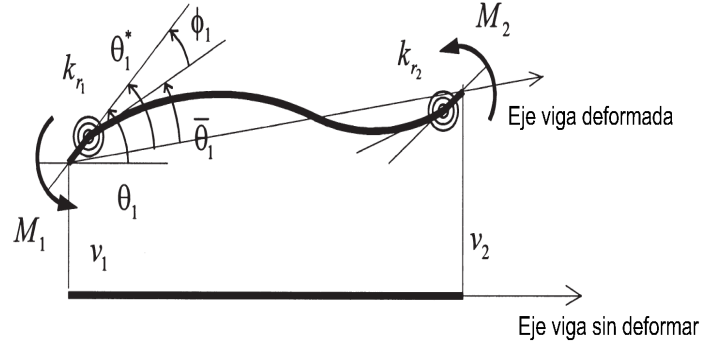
Deformada de una viga con conexiones semi-rígidas [6]
